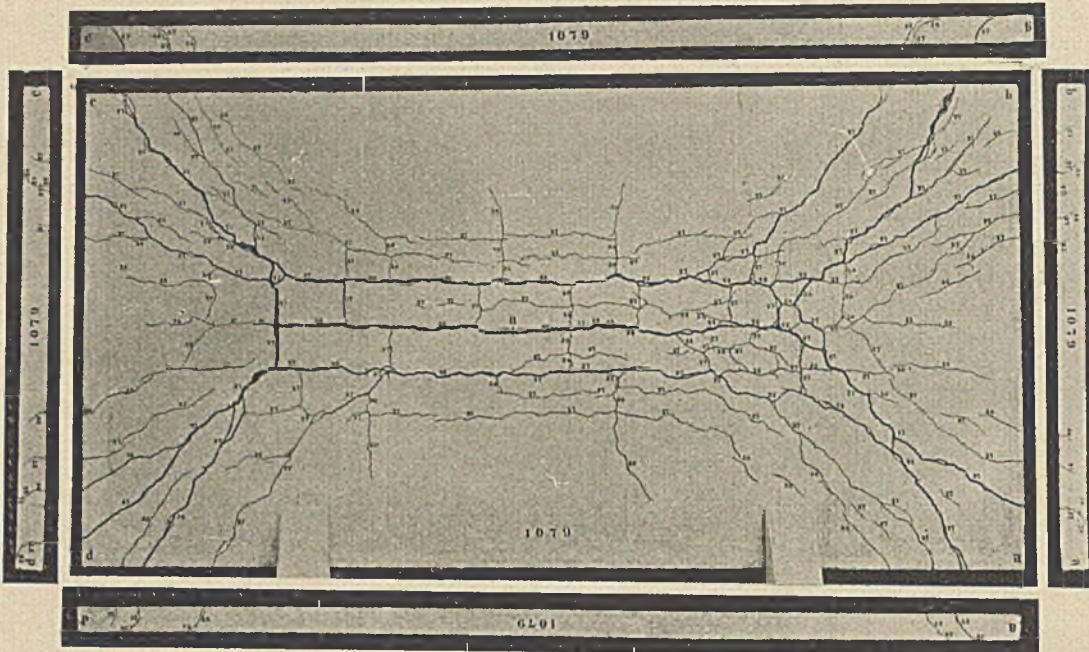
Untere Fläche und Seitenflächen der Platte nach Bauart 2 (Bewehrung parallel den langen Seiten, im Vergleich mit Platte 1 auf die Hälfte vermindert).
